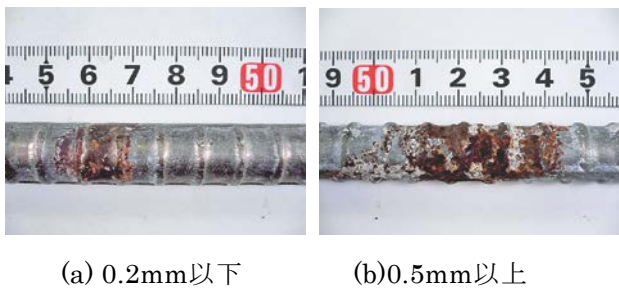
ひび割れ部鉄筋の腐食状況の例
